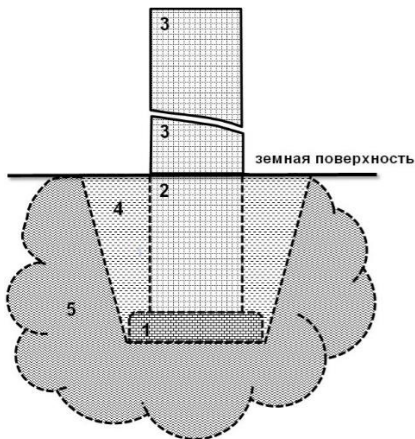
Схема размещения подземной части здания и структуры окружающей его геологической среды: 1 – фундамент, 2 – подземная часть здания (подземные этажи); 3 – надземная часть здания (надземные этажи); 4 – котлован, заполненный материалом обратной засыпки (насыпным техноземом); 5 – зона техногенного влияния на состояние земной коры
